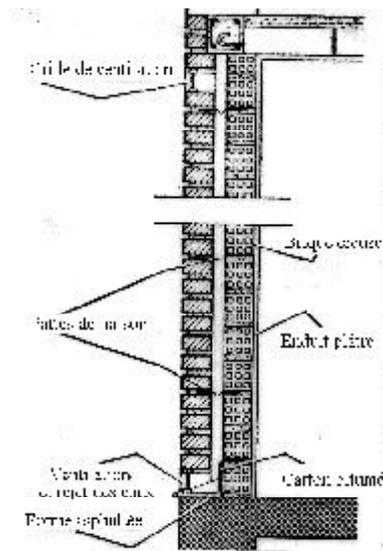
Exemple d'un mur à double paroi en briques pleines et perforées en nombre entier entre planchers
